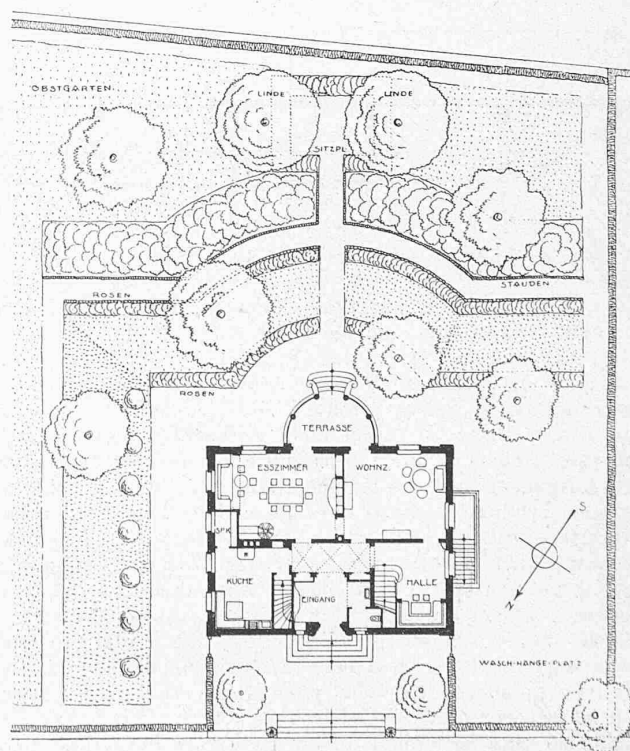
und 2. Grundrisse des Hauses Dennler in Langenthal. — 1:400.
